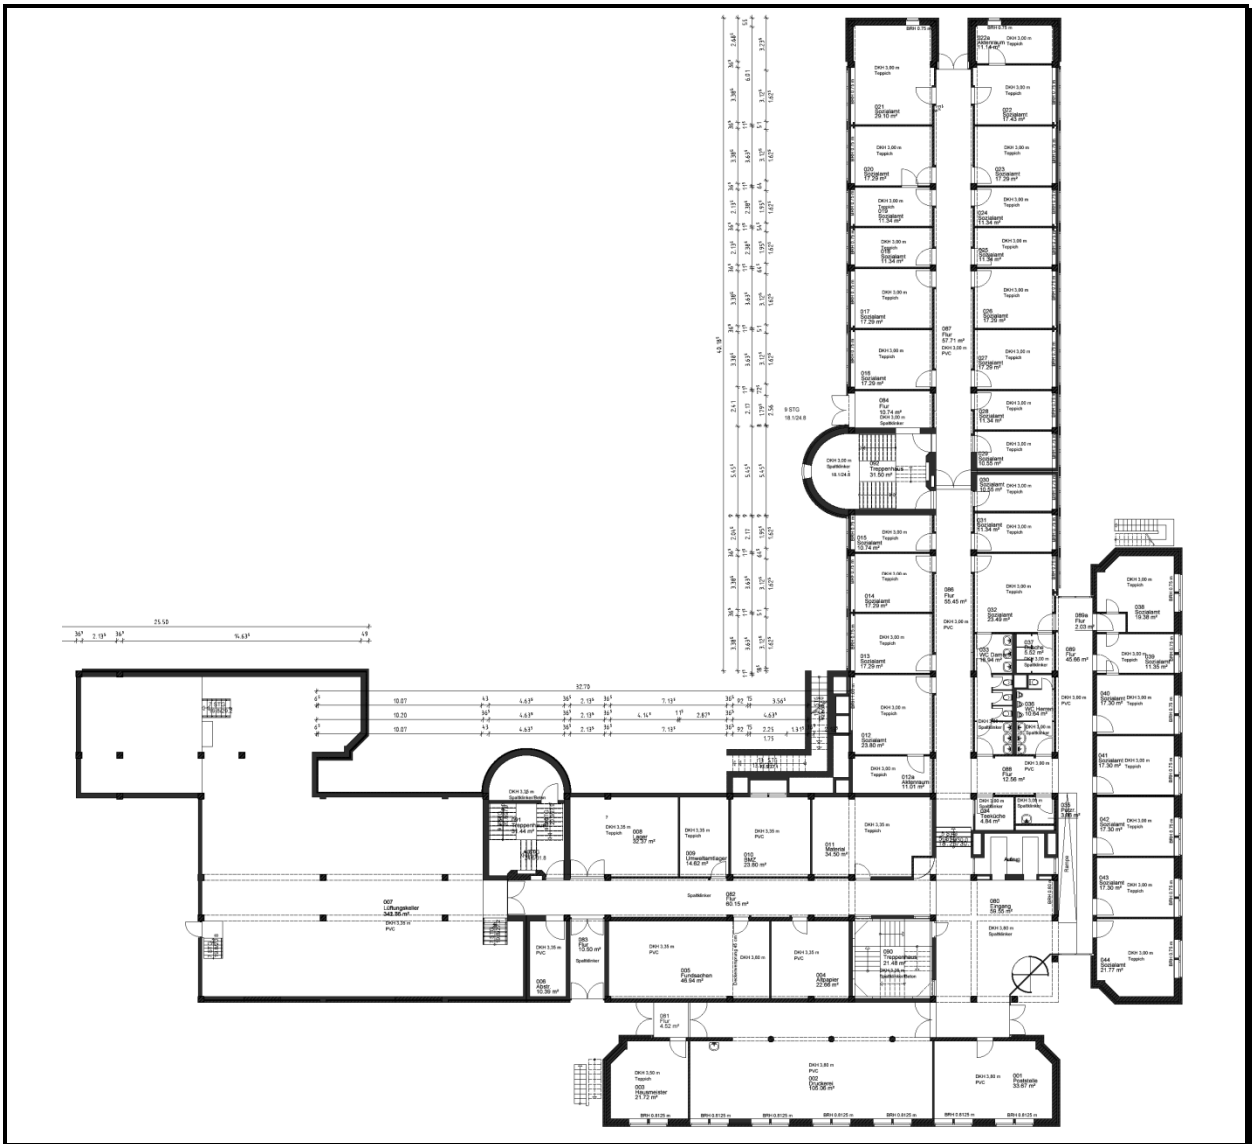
Rathaus: Grundriss EG
